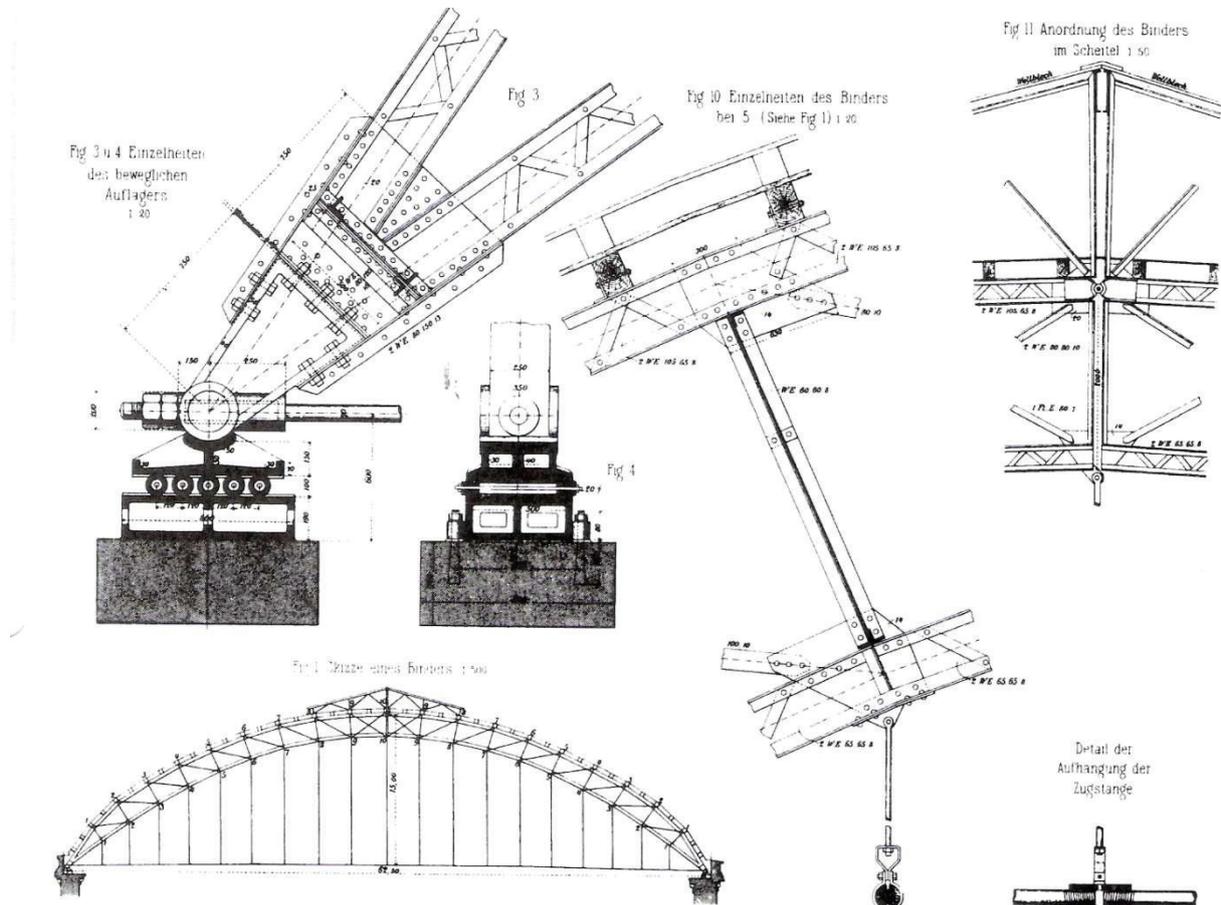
Konstruktionsdetails Hallendach Anhalter Bahnhof 1872-1880 [27]
